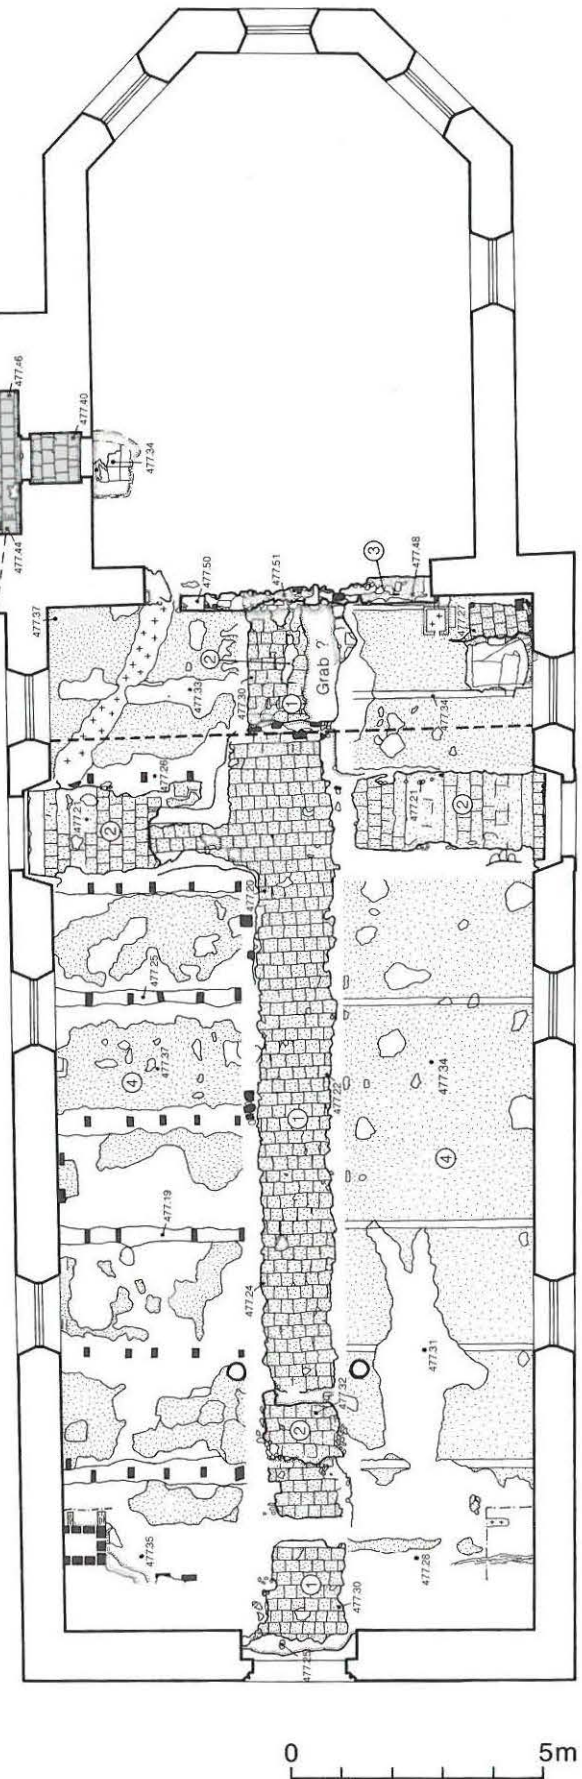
Grundriss der Befunde nach Entfernung der Banklager von 1932. M. 1:150. 1 Reste der gotischen Mörtelunterlage mit Plattennegativen, 2 Reste der barocken Mörtelunterlage, 3 Chorstuftengrundament, 4 Ausgleichsmörtel des Bodens von 1872.
